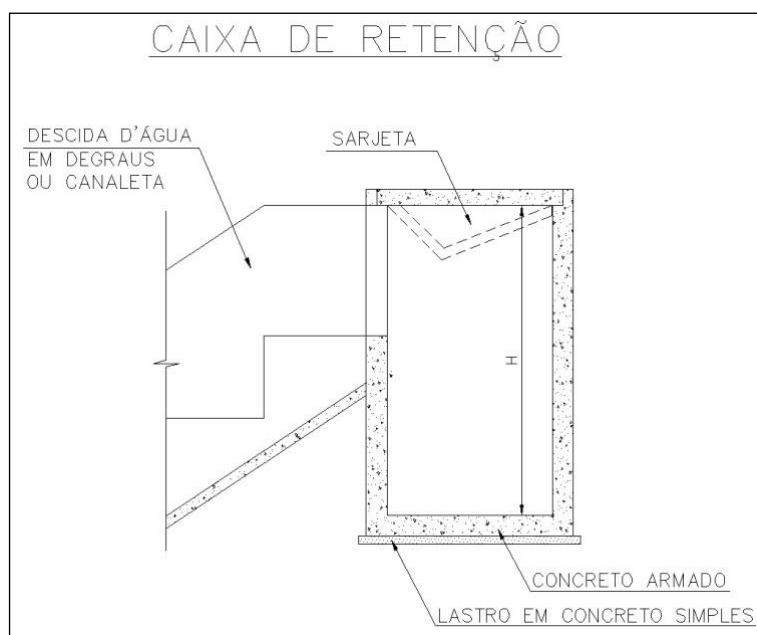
Dimensão da caixa de retenção CR – E- 02B
